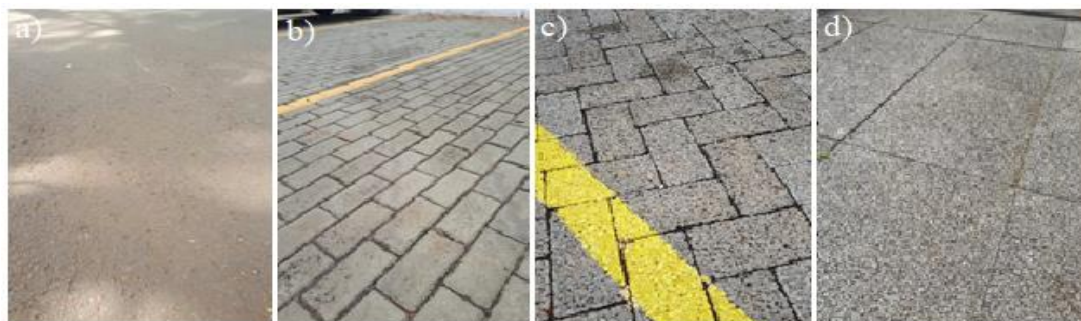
(a) Pavimento convencional; (b) Bloco de concreto intertravado; (c) bloco de concreto intertravado drenante; (d) Bloco de concreto poroso.
